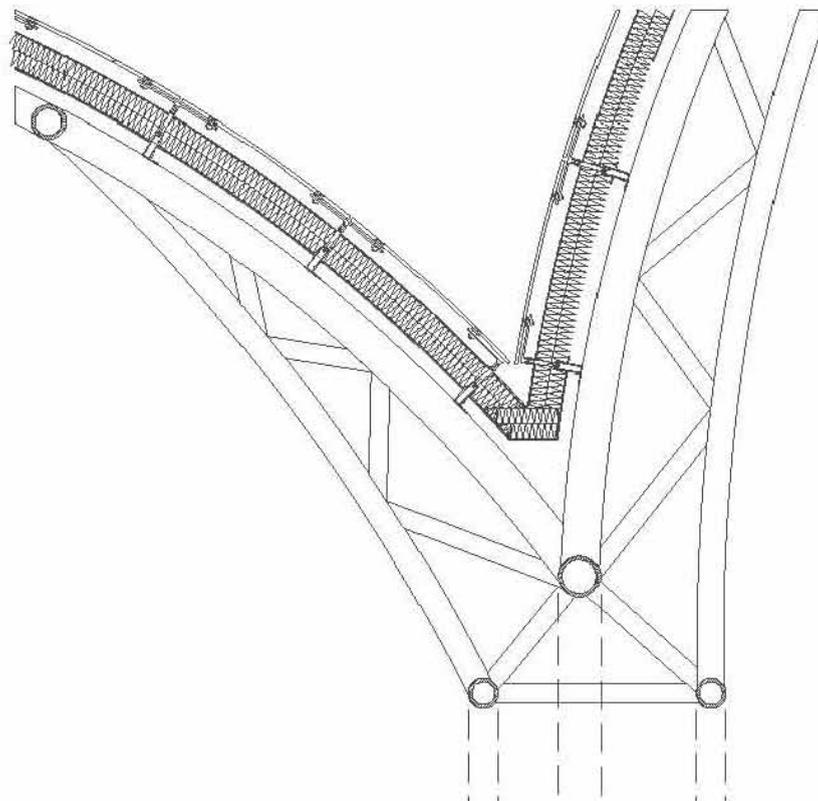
Detailschnitt Kuppelüberschneidung M 1:40
